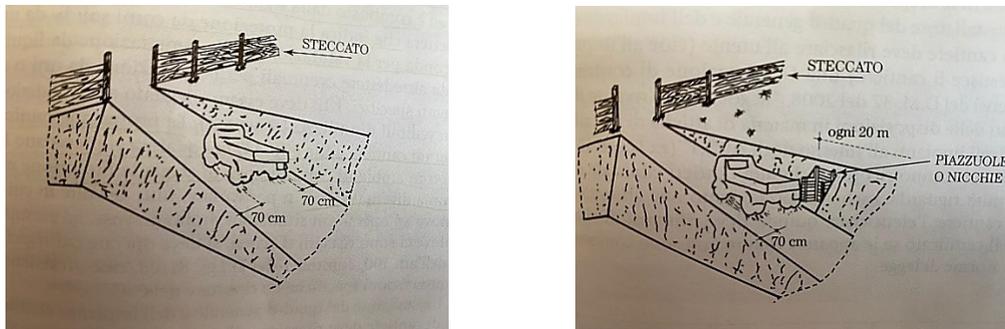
Schemi illustrativi delle disposizioni minime da rispettare nell'organizzazione della viabilità
